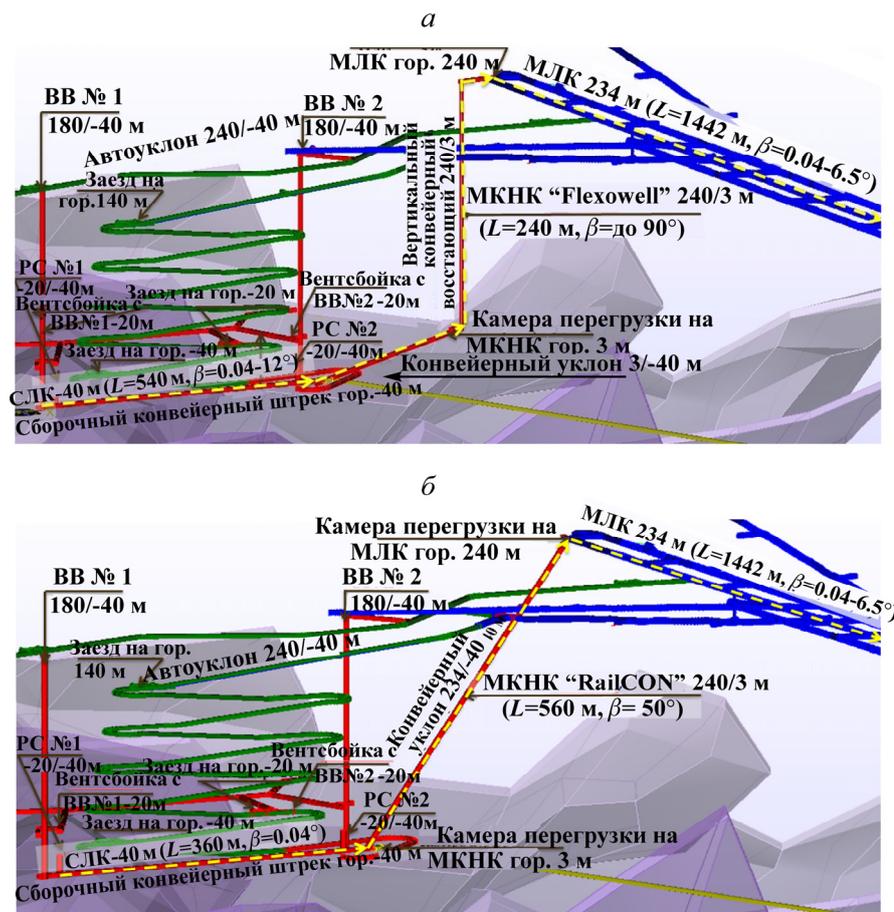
Схема вскрытия: *а* — № 2 с транспортированием руды горизонтально-наклонным и вертикальным конвейерами; *б* — № 3 с транспортированием руды ленточным и крутонаклонным конвейерами
